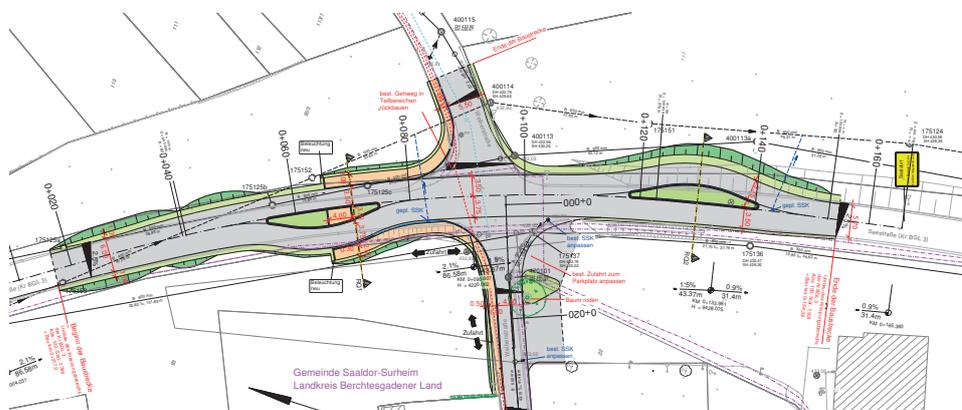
Lageplan Verkehrsplanung Saaldorf Süd
